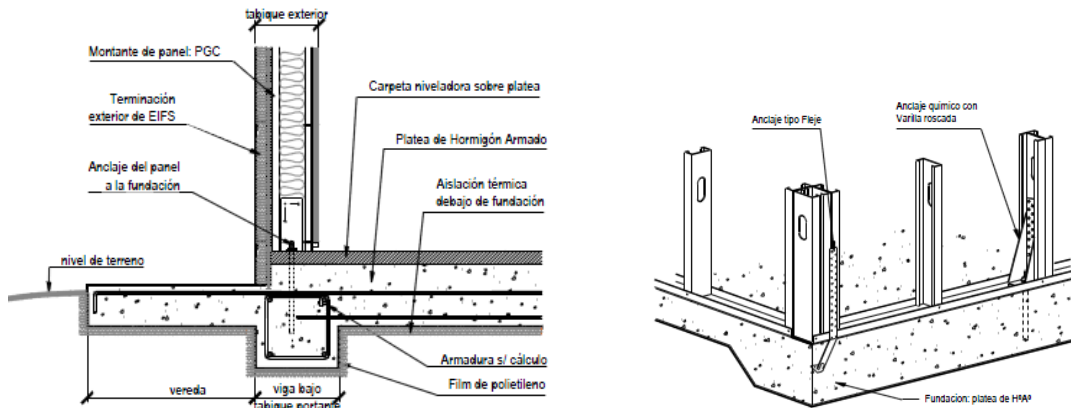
Unión entre cimentación y muro y tipos de anclajes. (ConsulSteel, 2002).
